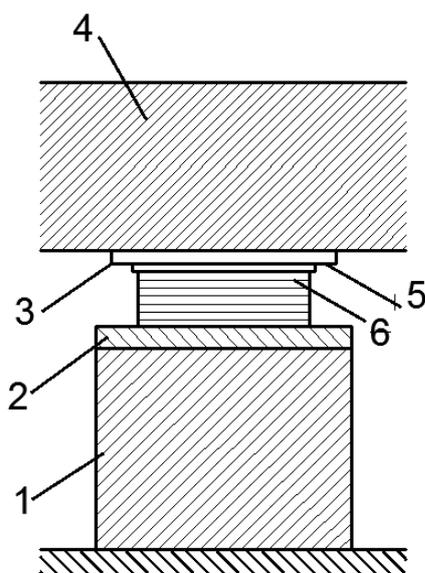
Сейсмоизолирующая опора фирмы Spie Batignolle (1 – бетонная опора, 2 – железобетонный оголовок; 3 – фрикционные пластины; 4 – верхняя фундаментная плита; 5 – плоскость трения; 6 – неопреновая прокладка)
